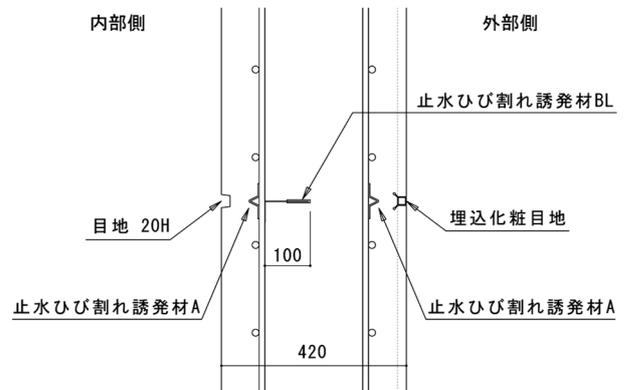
外壁 止水機能付 ひび割れ誘発目地 断面図
